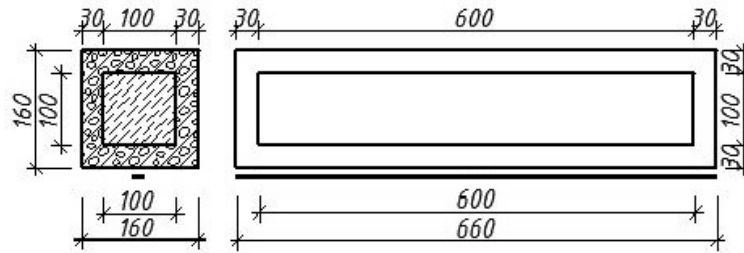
Комплексна легкобетонна балка, посилена композитною арматурою (Б-2п, Б-3п та Б-4п)
